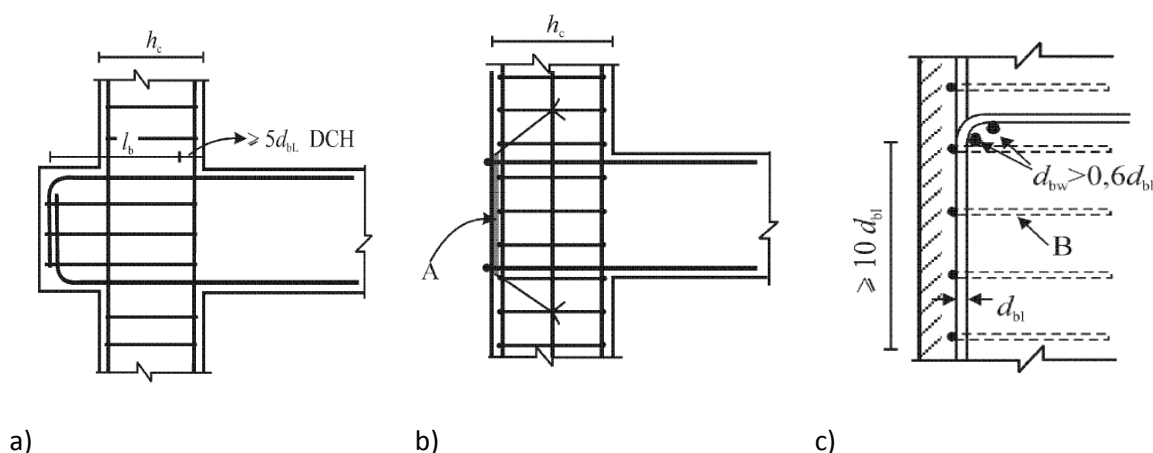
Disposições adicionais para amarração nos nós viga-pilar exteriores
